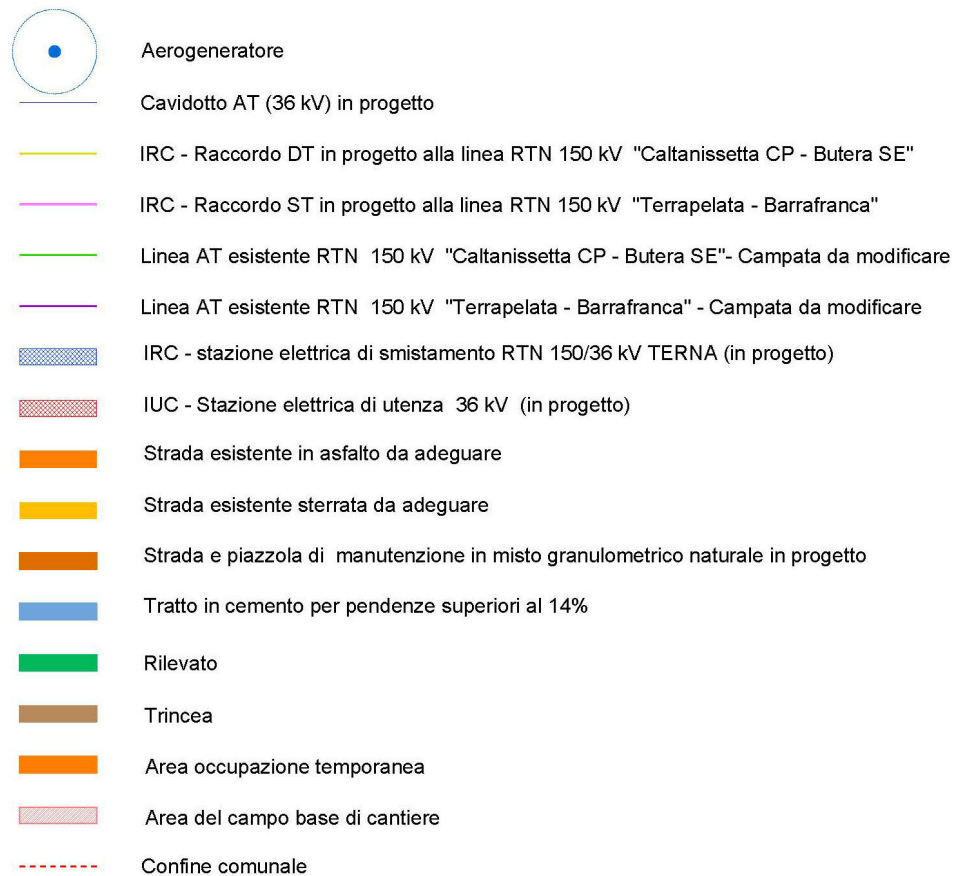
Legenda planimetrie delle strade di cantiere
